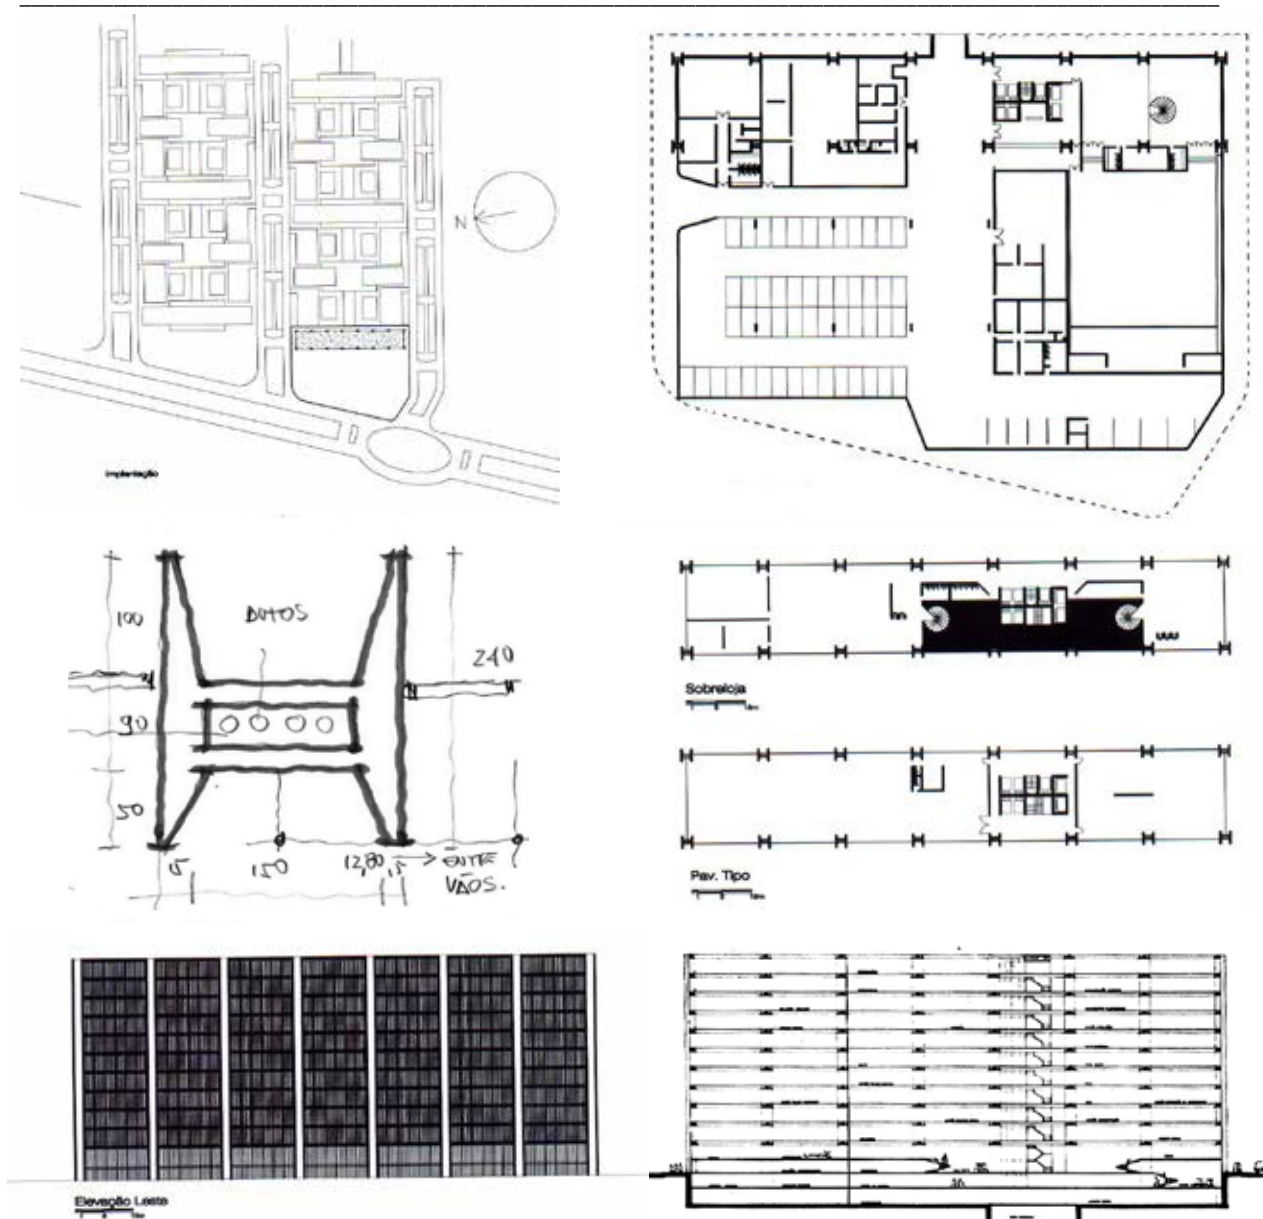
1º prêmio concurso Departamento Federal de Segurança Pública; planta de situação; Fig.413: (sup. dir.) planta de subsolo; Fig.414: (meio esq.) seção esquemática do pilar em "H"; Fig.415: (meio dir.) planta mezanino e planta pavimento térreo. Fig.416: (inf. esq.) elevação frontal; Fig.417: corte longitudinal.
